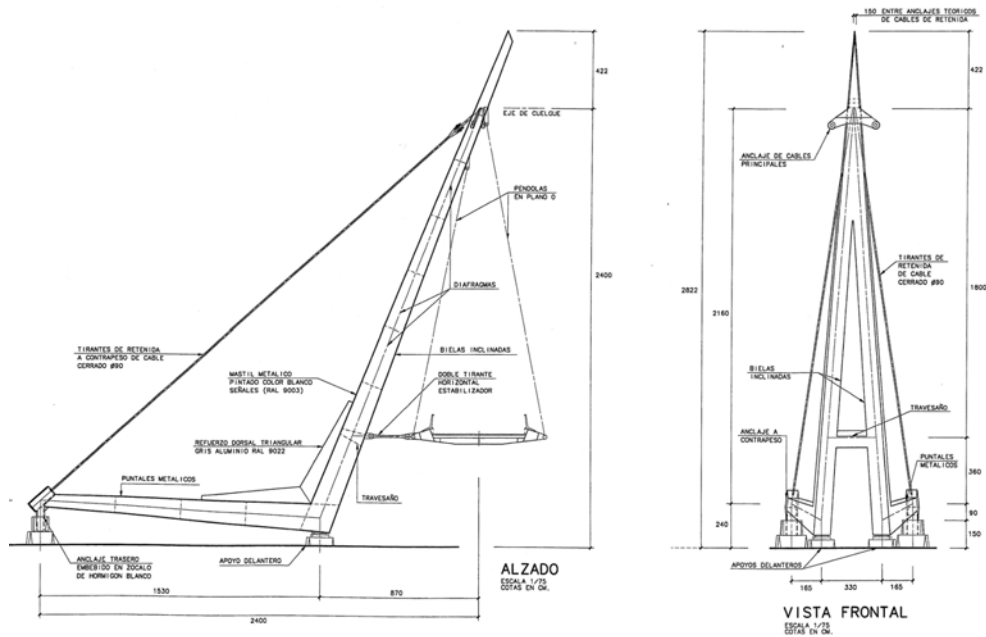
Plano de definición general de la estructura metálica del mástil inclinado
